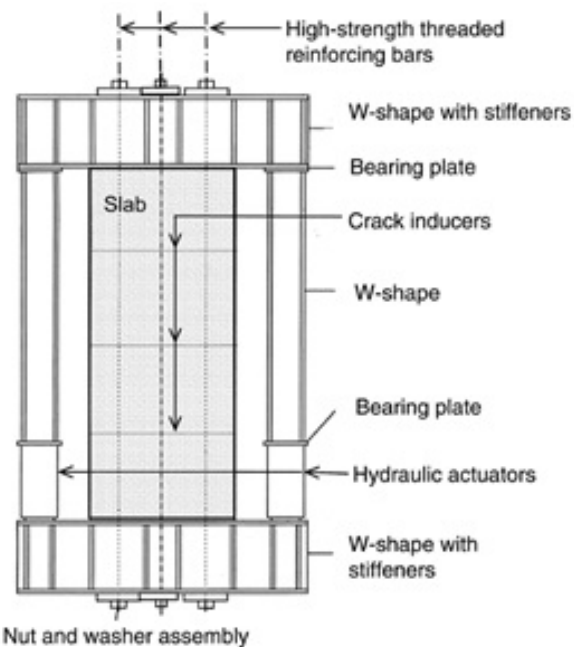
Montaje propuesto por ACI 355.4-11 para fisuración.
